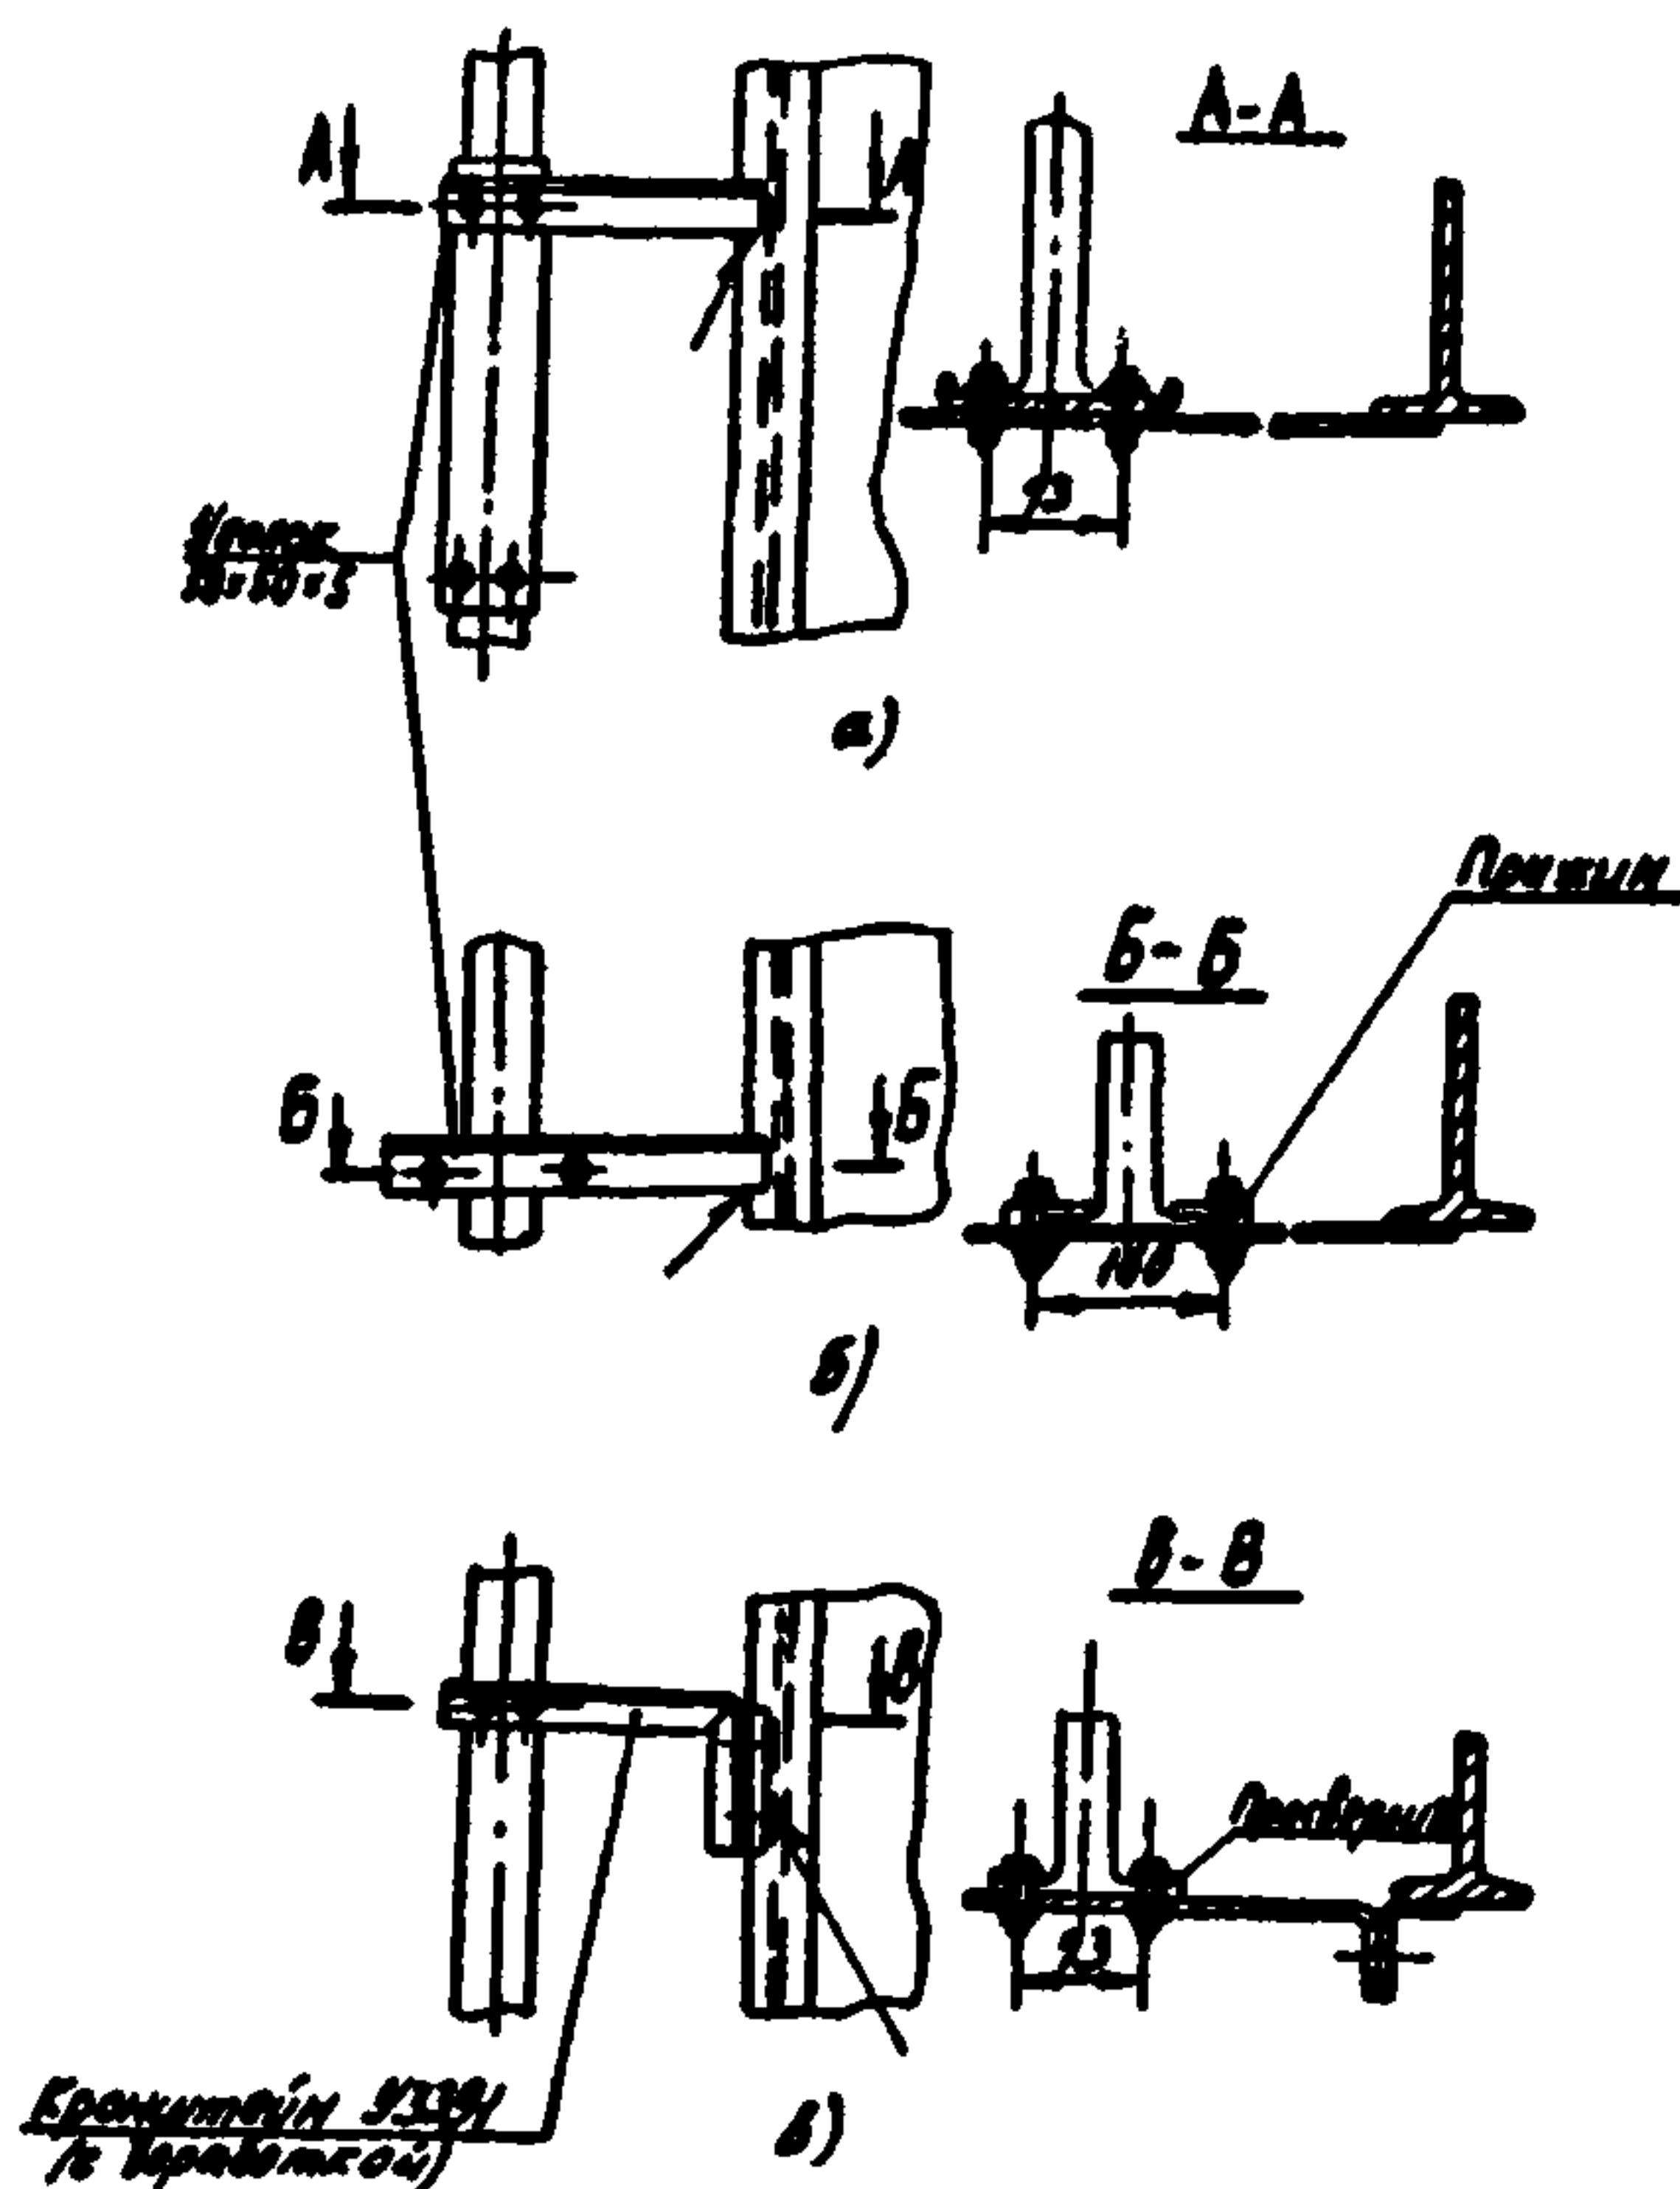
Крепление вертикальных участков шинопровода ШМА4 на 1250 и 1600 А при его положении к стене (колонне) широкой стороной:
